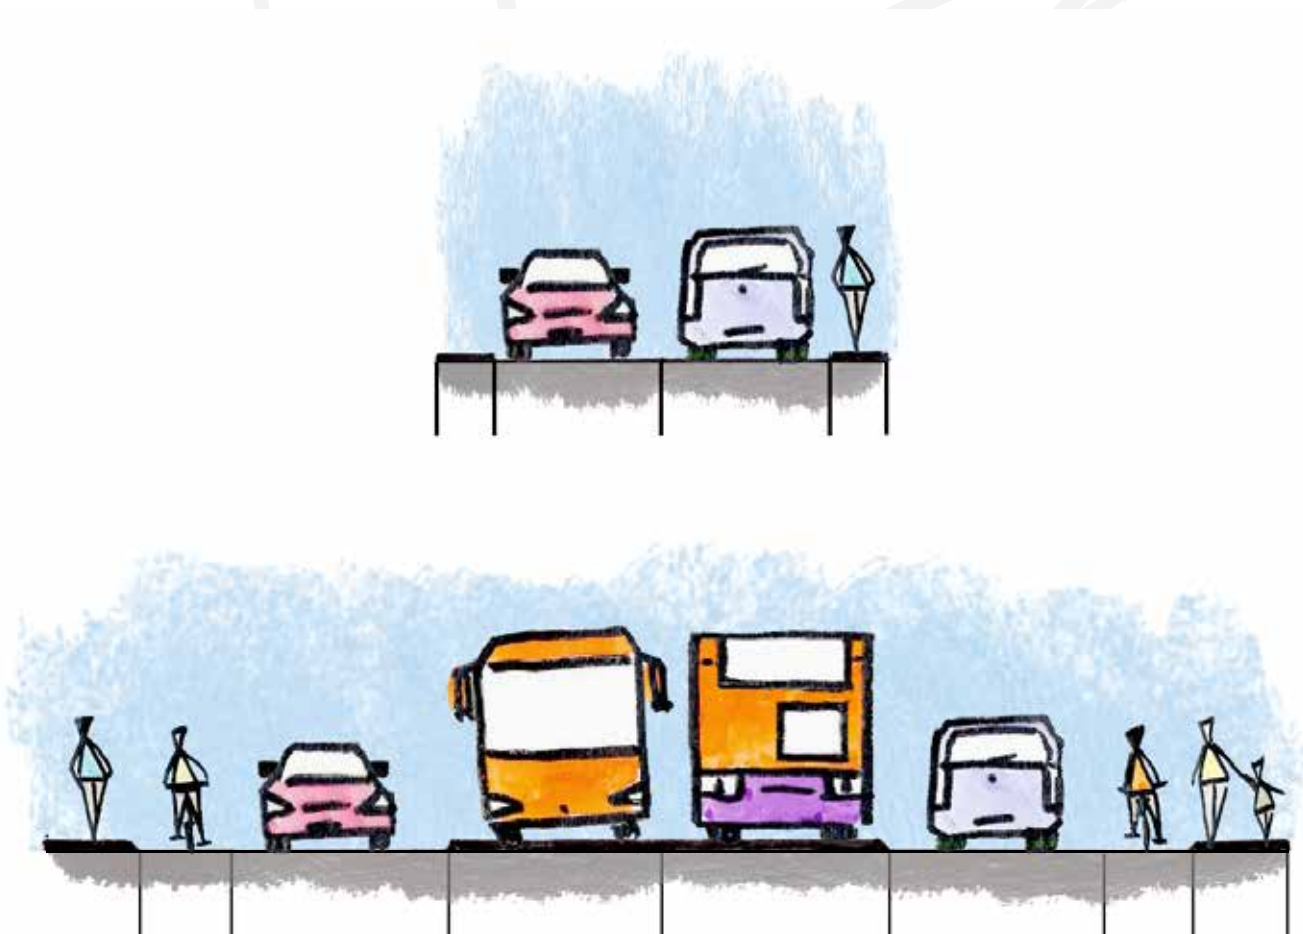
Profil de chaussée sans site propre (en haut) et avec site propre (en bas) (Pierre DUHAMEL)
